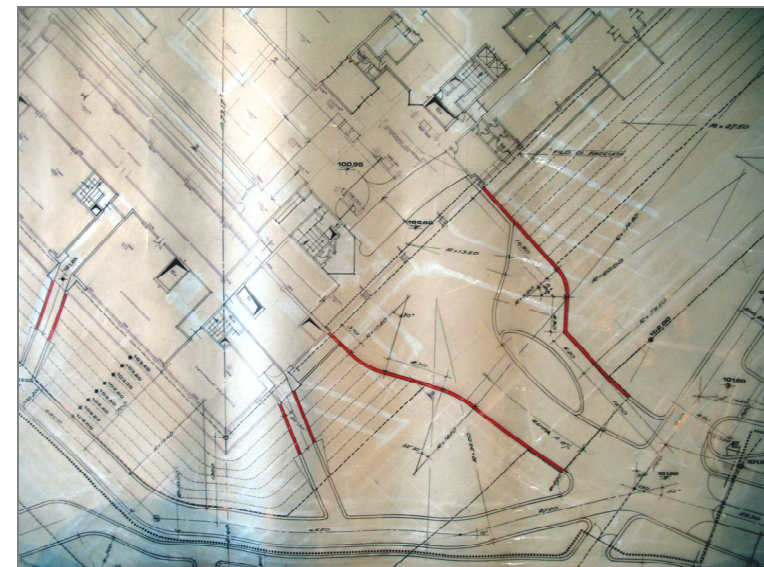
planimetria settore est (fonte CSAC – stralcio tav. 51, archivio n. 384-1)
